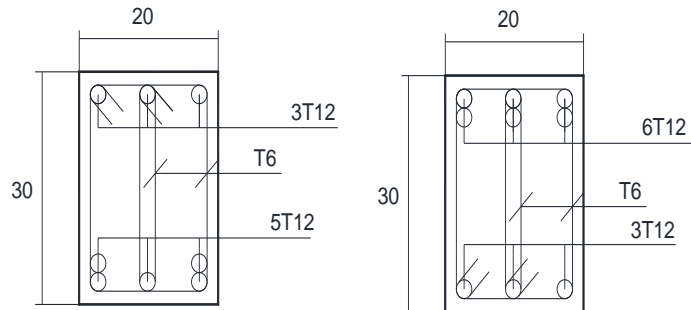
Coupe longitudinale d'une poutre secondaire 20x30cm (bâtiment R+7)
